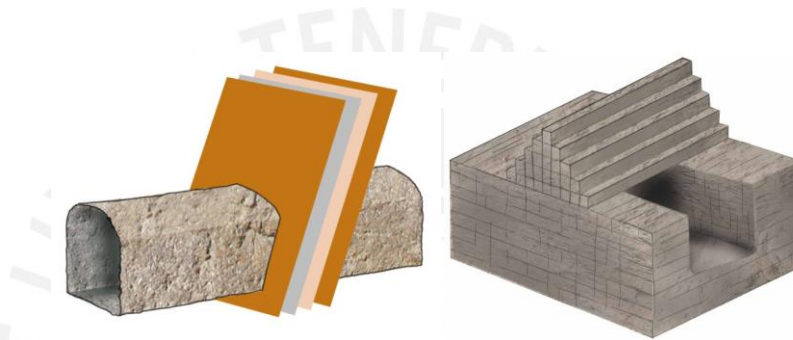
Condiciones favorables para la estabilidad de la excavación
